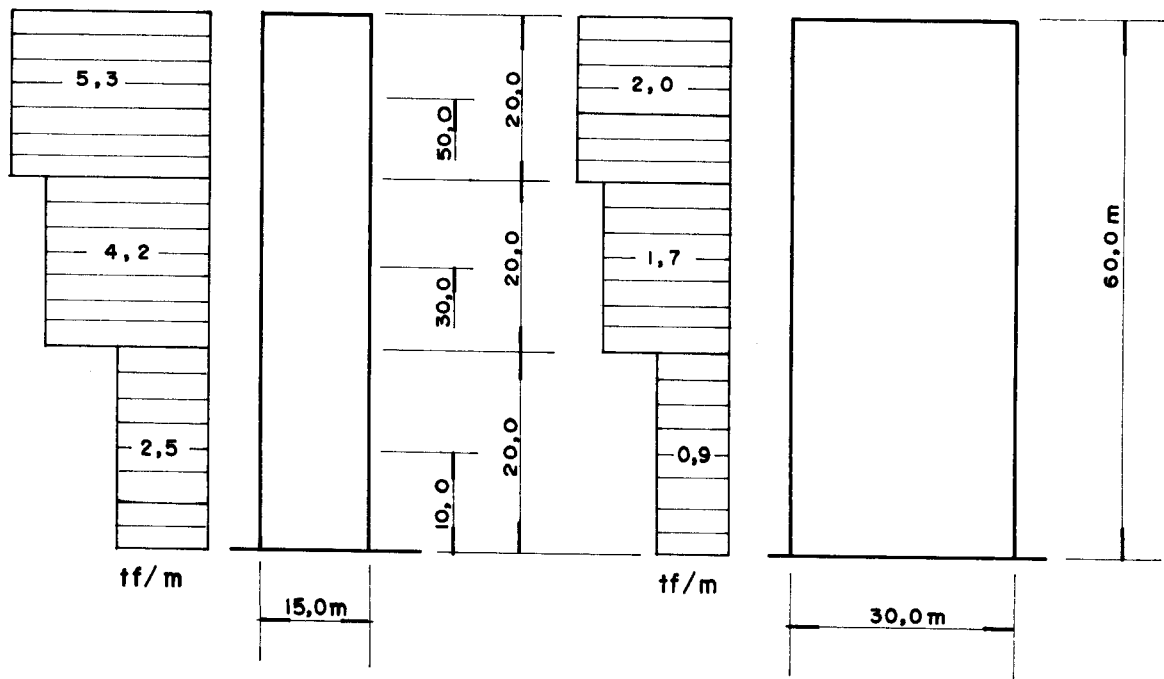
FORÇAS DEVIDAS AO VENTO EM UM EDIFÍCIO DE PLANTA RETANGULAR.
